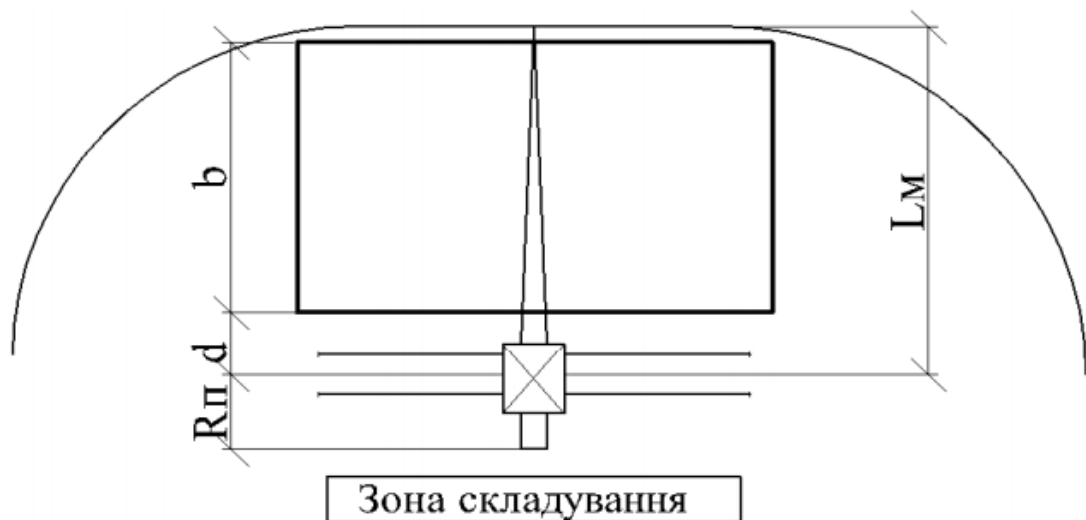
Схема установлення крану при зведенні багатоповерхової будівлі
